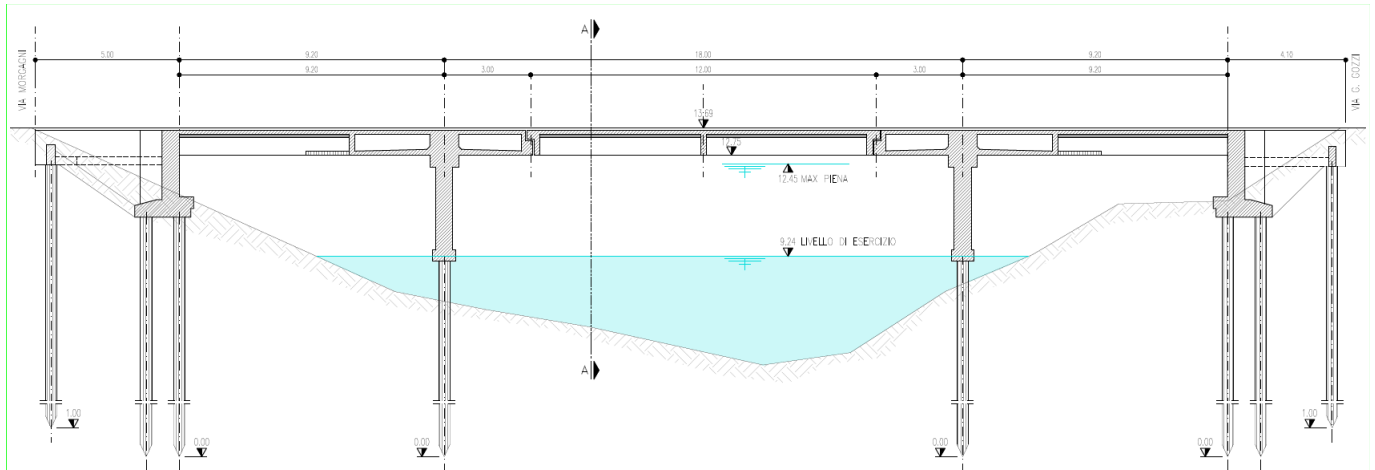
Sezione longitudinale del ponte S. Omizzolo – progetto (1958)
